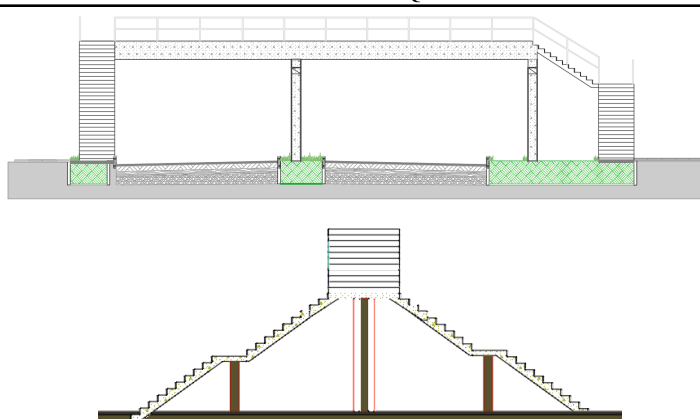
Levantamiento arquitectónico. Fuente: elaboración propia
